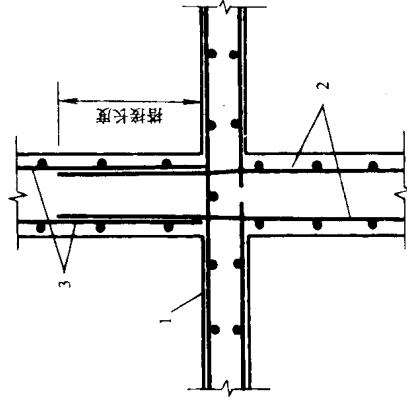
钢筋焊接网的竖向搭接
